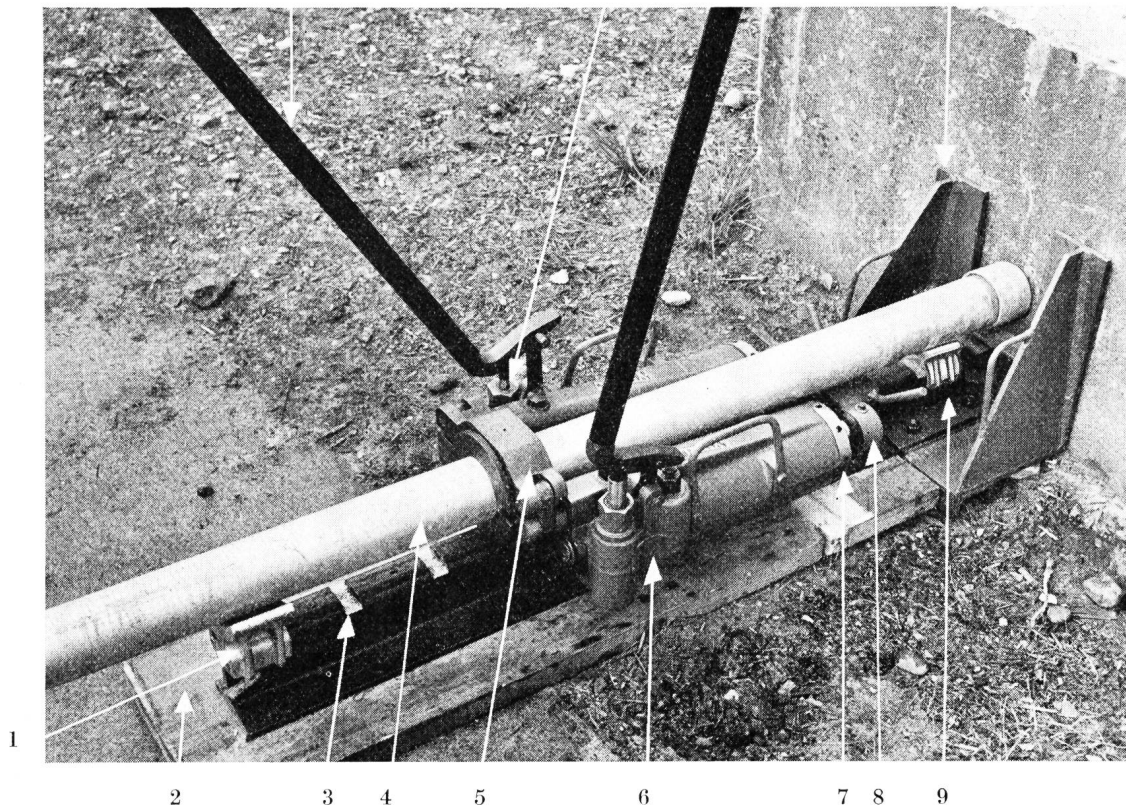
Hydraulisch zu betätigende Röhren-Stosswinde mit eingelegtem Rohr – Pousse-tubes hydraulique avec tuyau mis en place
